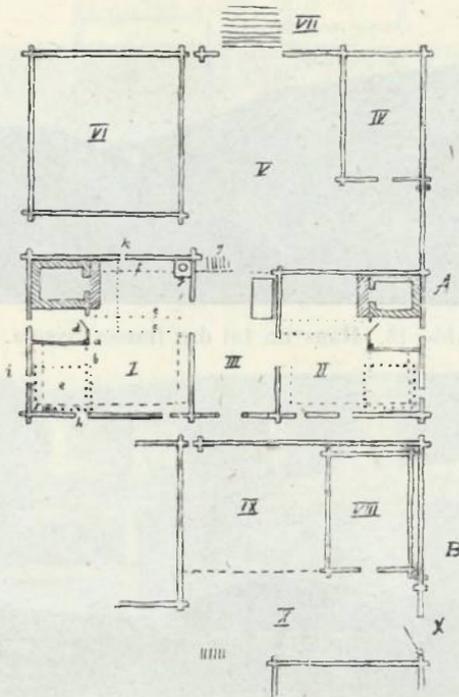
Grundriss desselben hauses wie in abb. 11.
